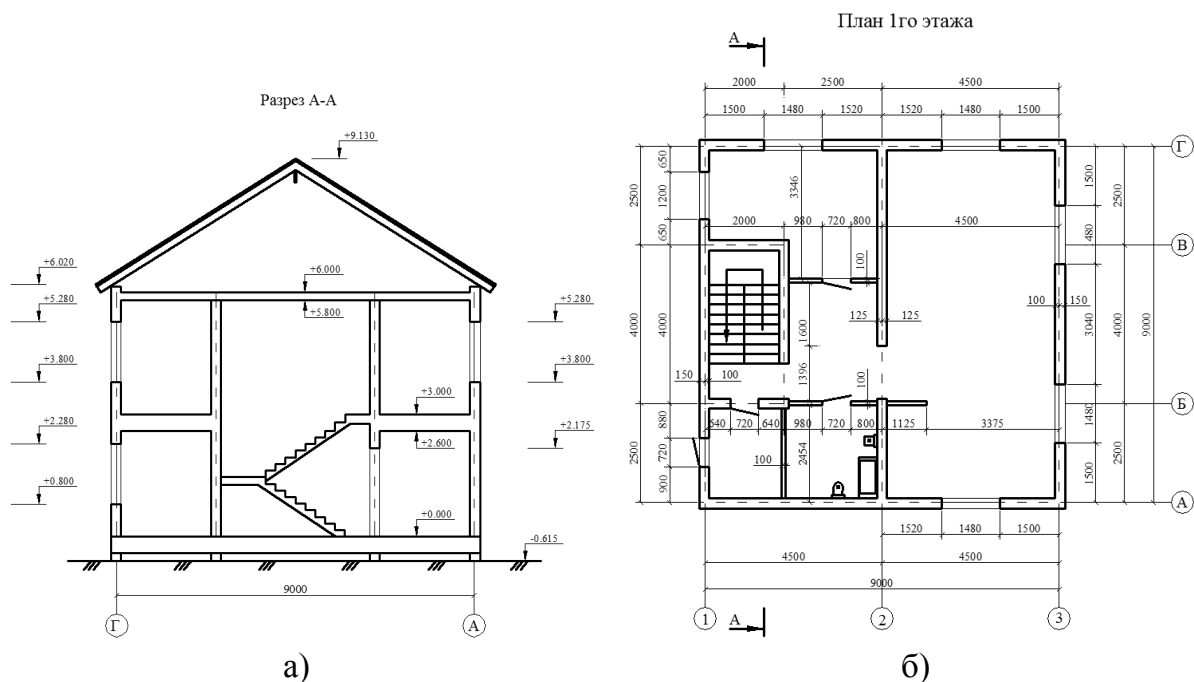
Двухэтажный дом площадью 162 м²: а – разрез; б – план первого этажа
